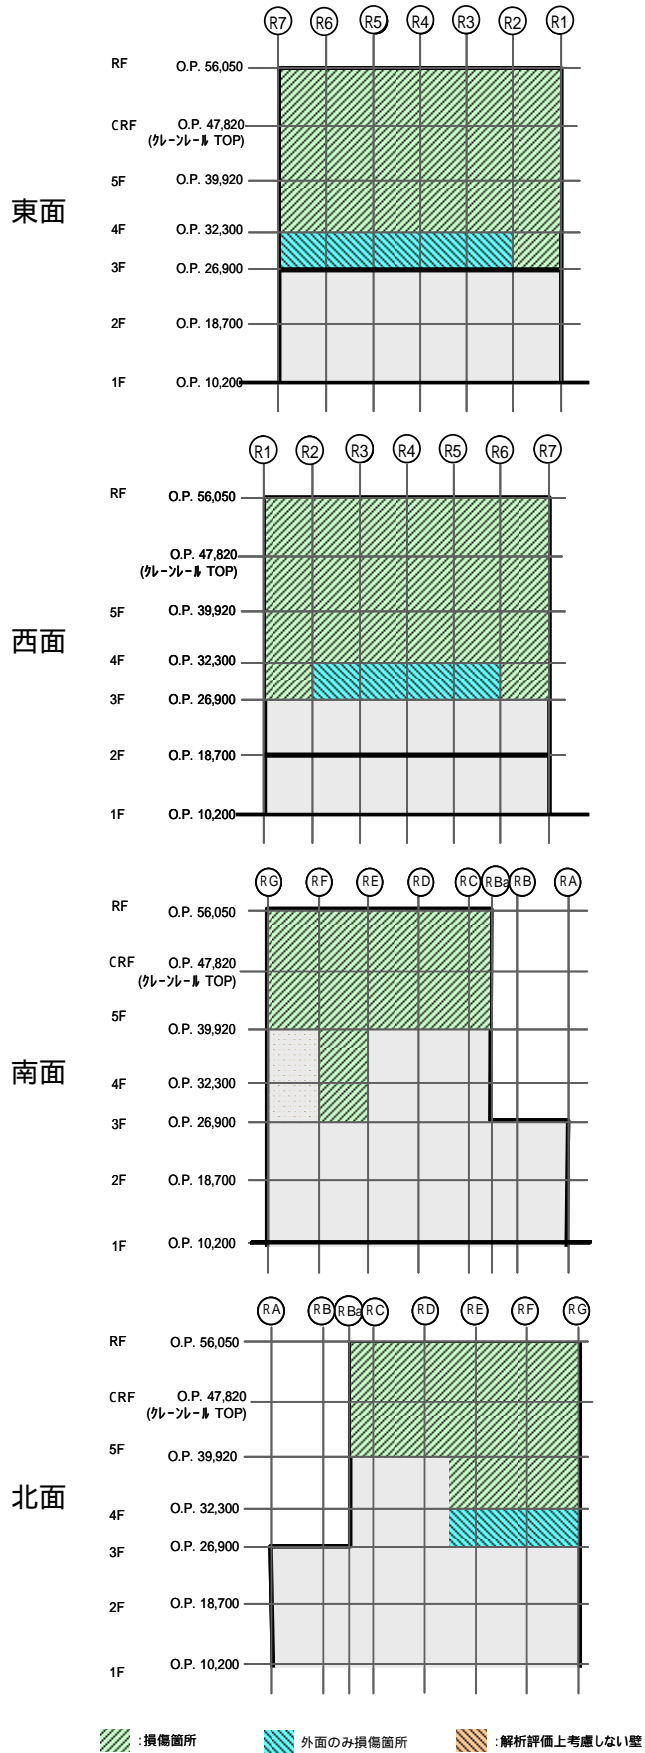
4号機原子炉建屋の損傷状況（立面図）
